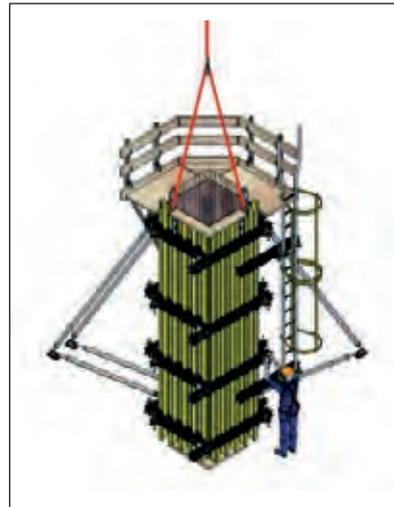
Encofrado de pilar con estabilizadores
